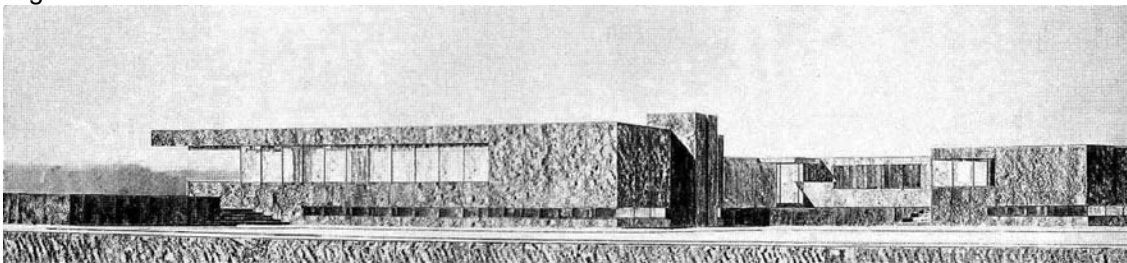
Perspectiva del proyecto para casa de campo de hormigón armado, 1922.
